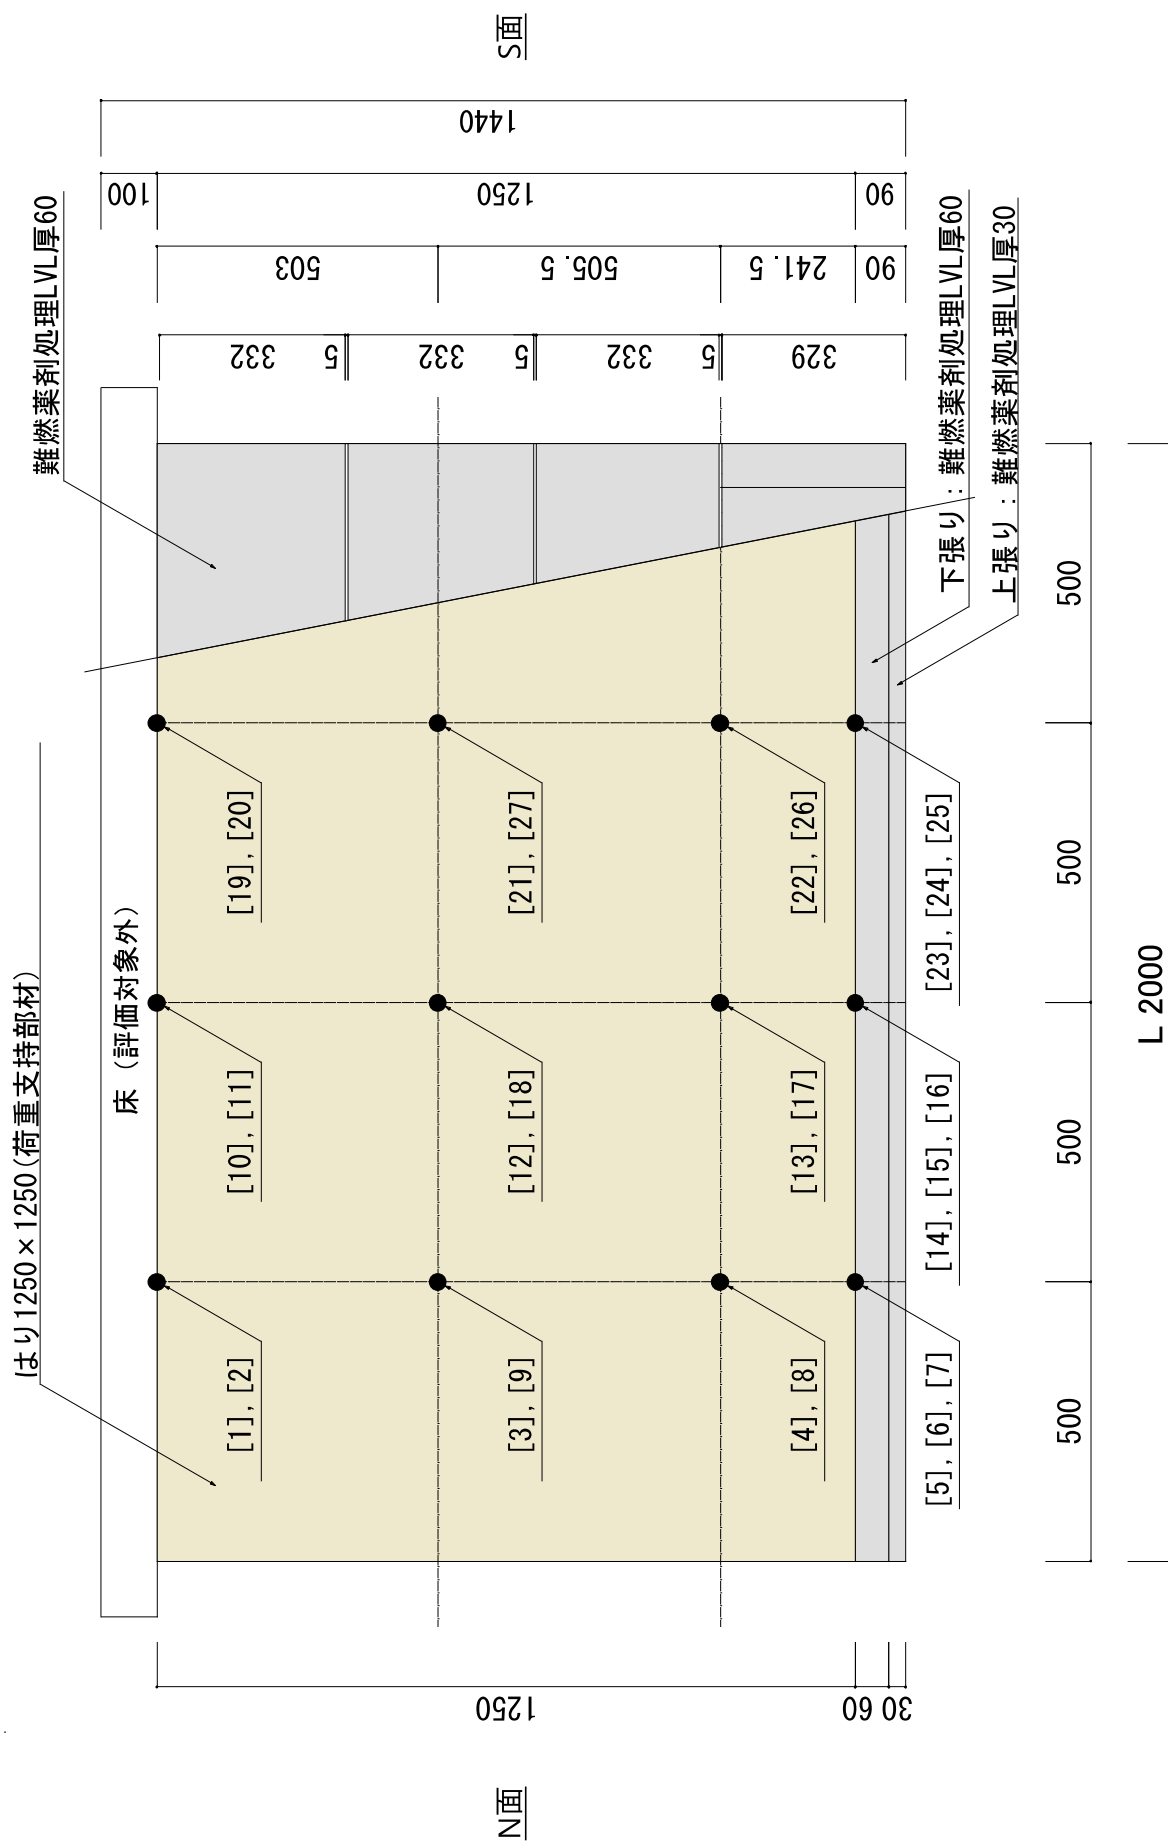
内部温度測定位置 (試験体B) (寸法単位：mm)
